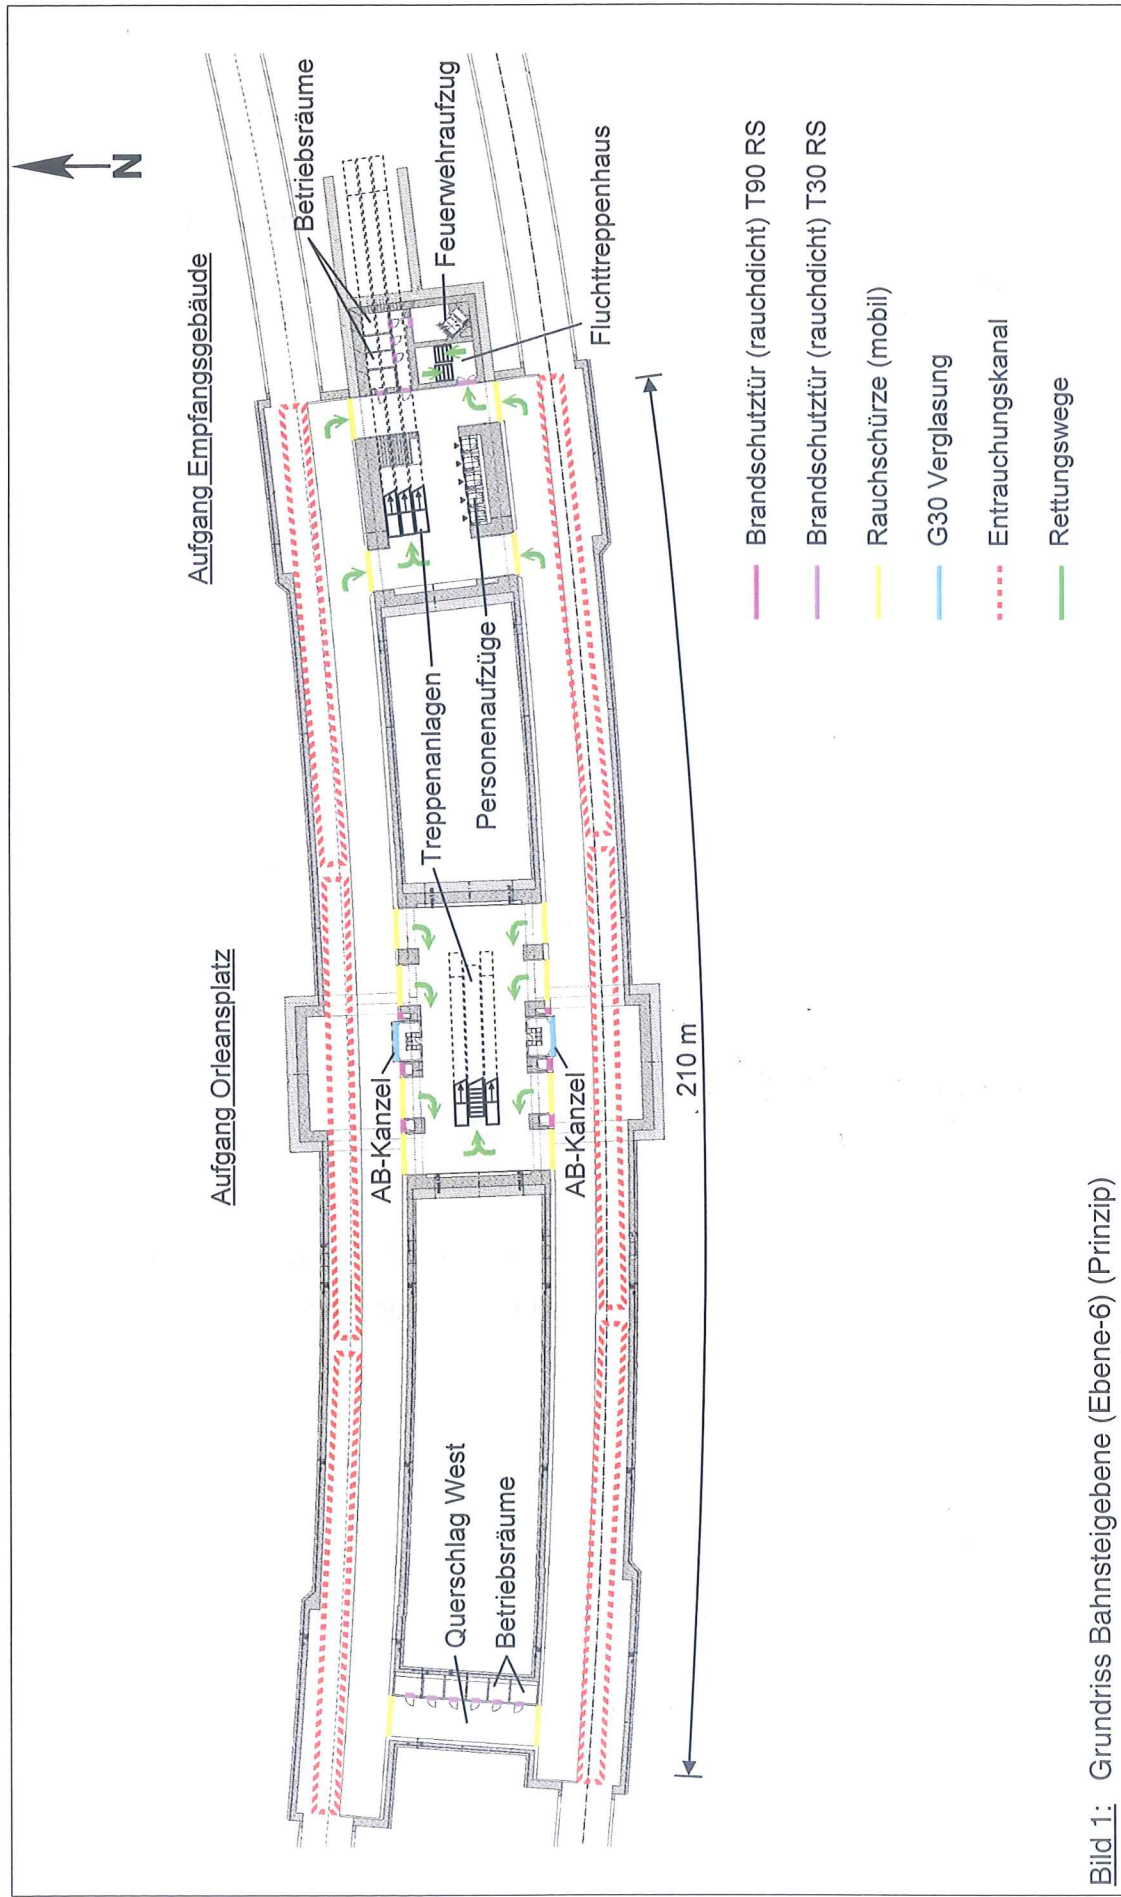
Grundriss Bahnsteigebene (Ebene-6) (Prinzip)
